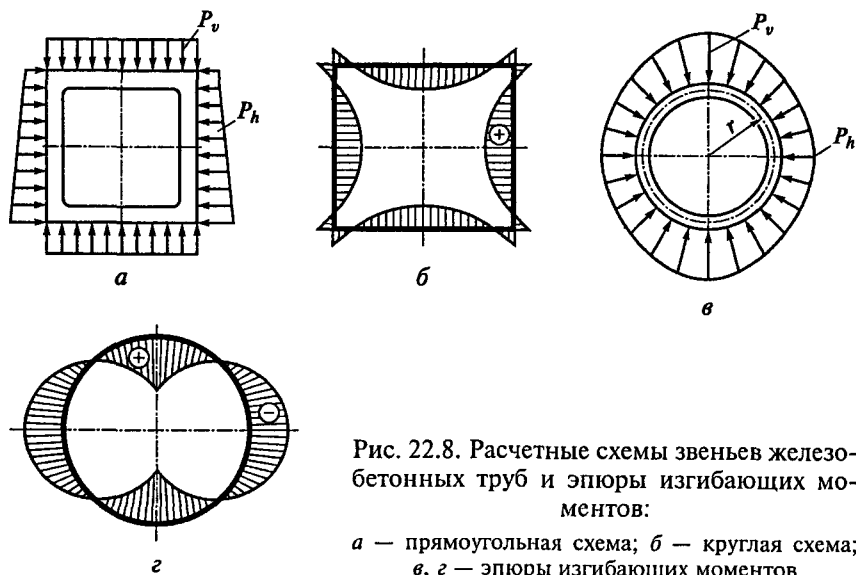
Расчетные схемы звеньев железобетонных труб и эпюры изгибающих моментов:
